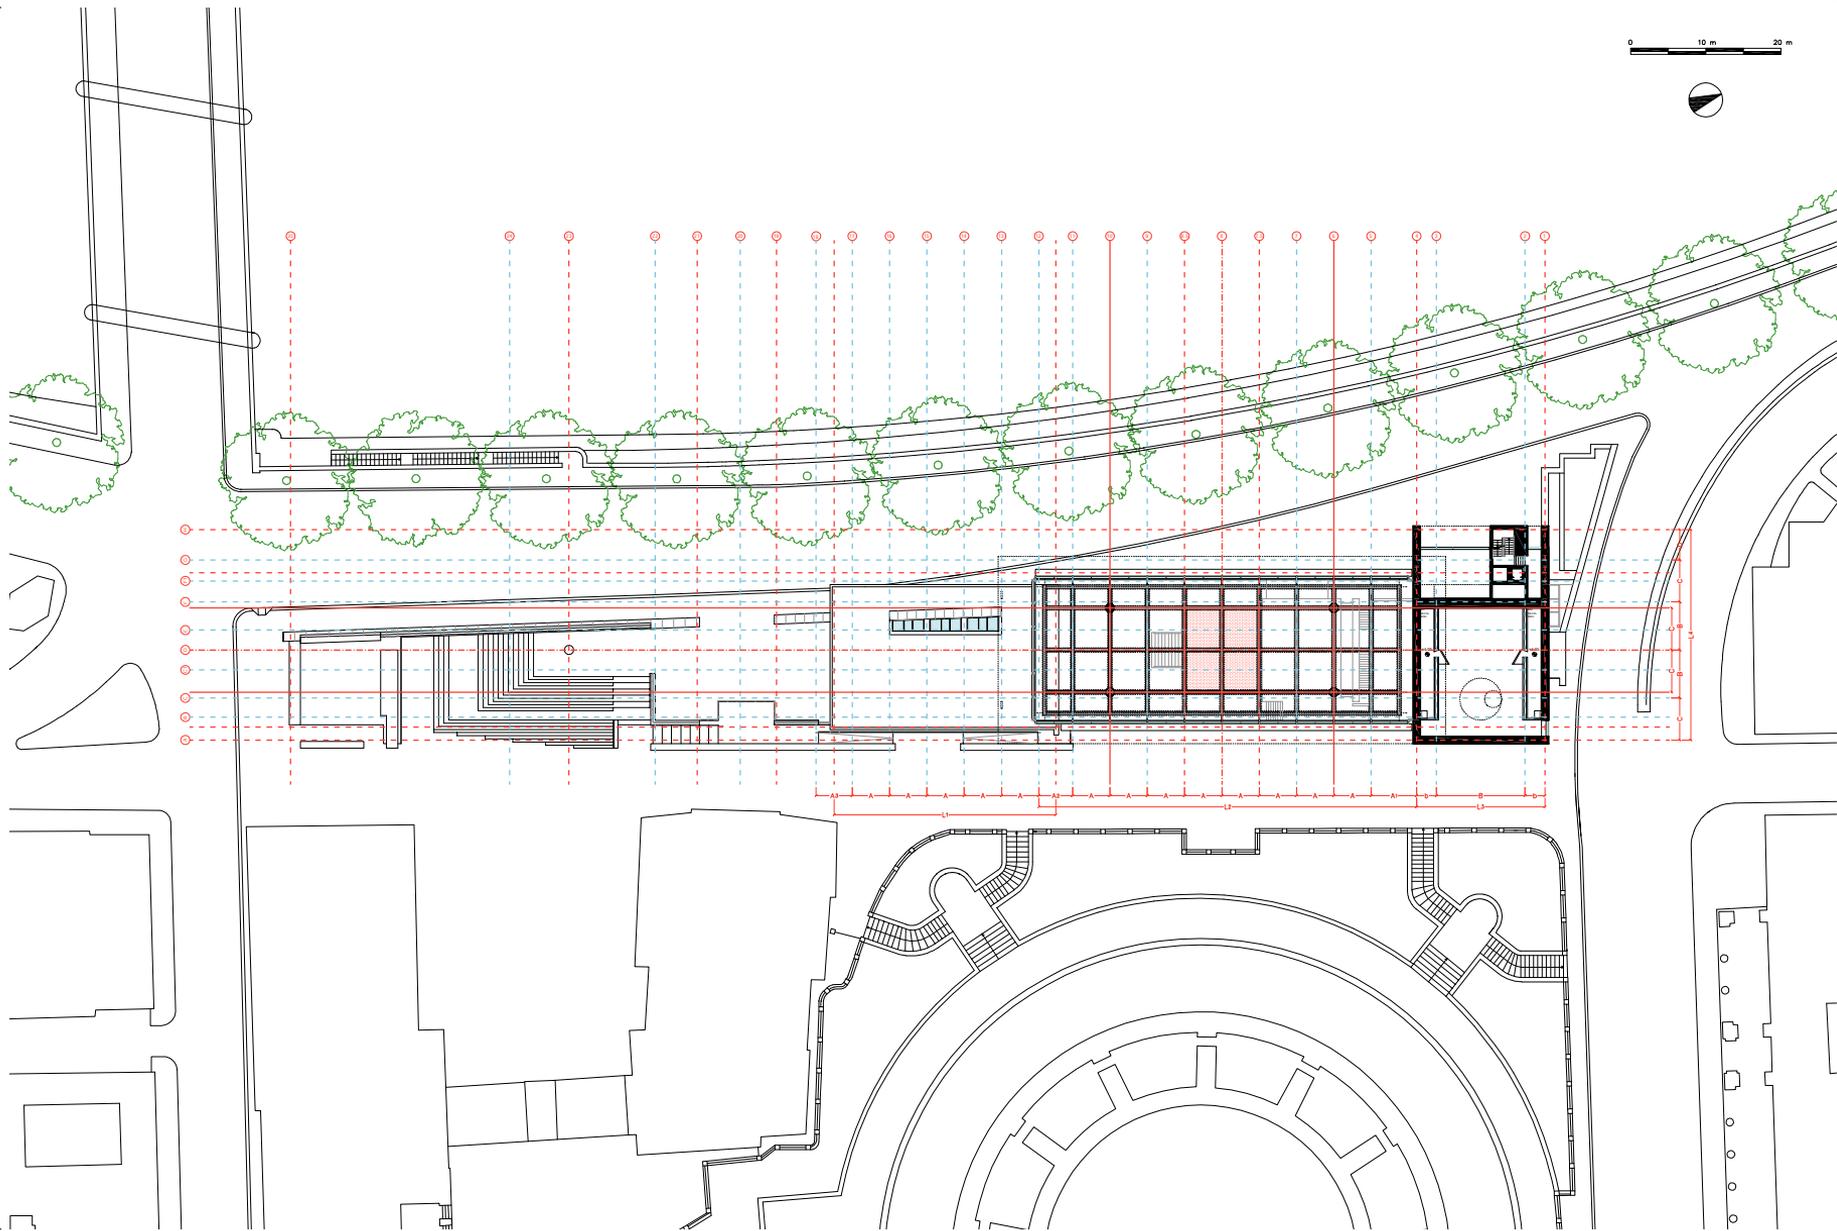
Museo dell'Ara Pacis, Roma, pianta coperture con individuazione del sistema di modulazione.
